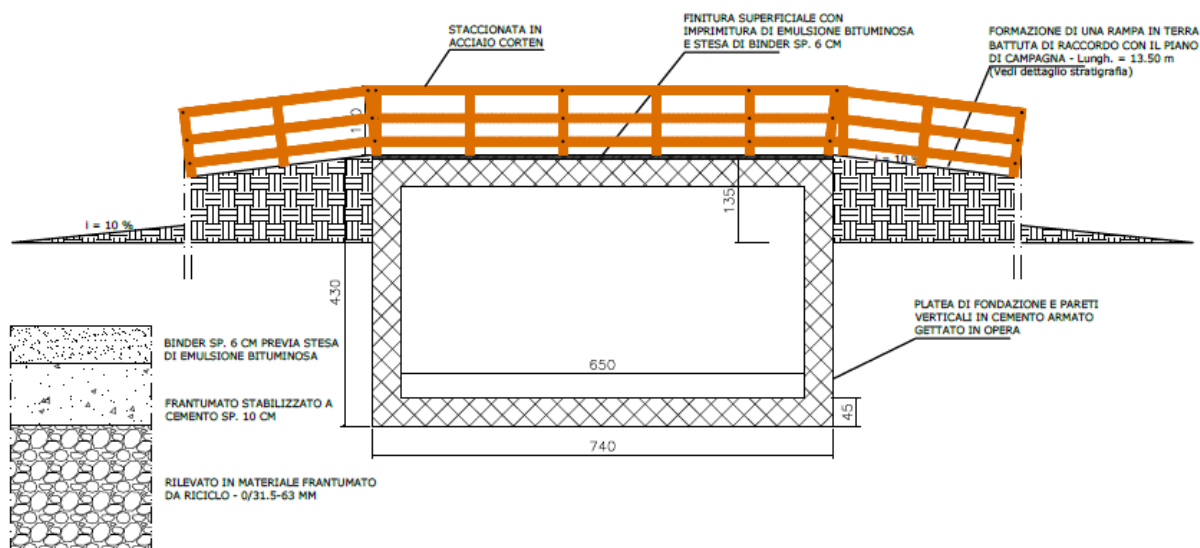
Sezione tipologica degli attraversamenti in progetto.
